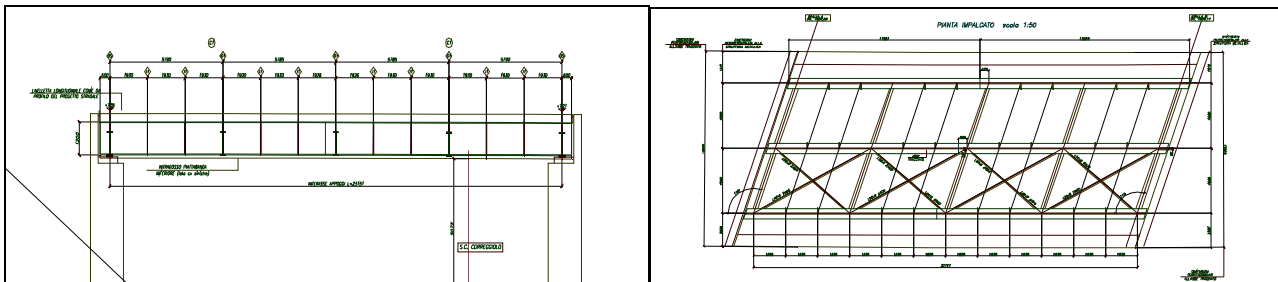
Profilo longitudinale e Planimetria dell'impalcato
